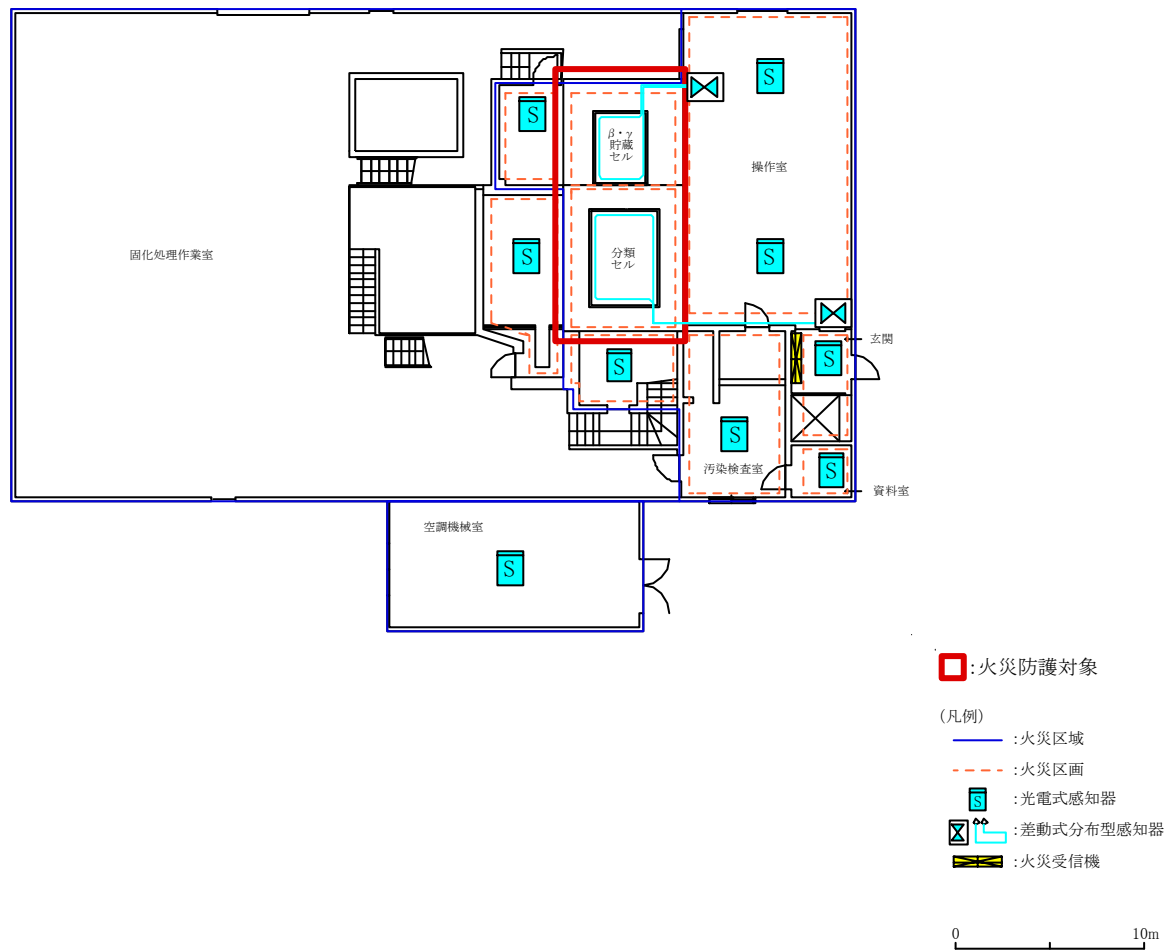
1 0 β・γ 固体処理棟Ⅳ 1 階平面図
